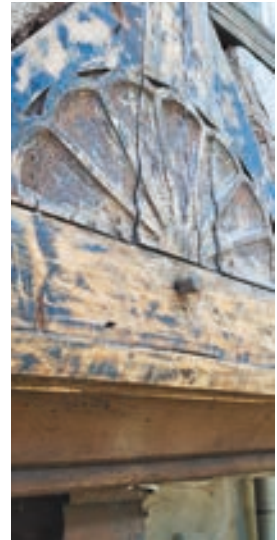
Obere Straße 37 Erkerdetail, Stadt VS.
